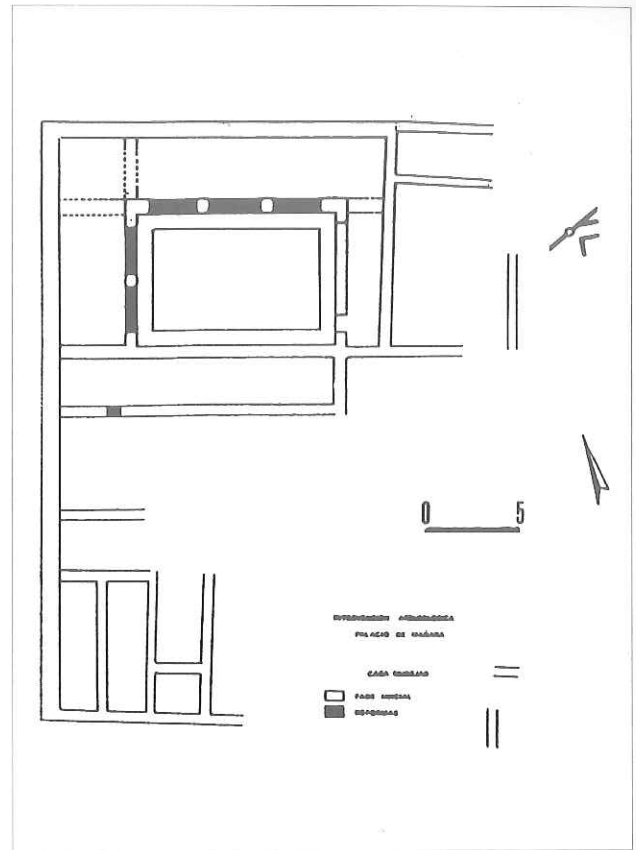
Planta con las estructuras de nueva construcción de la Casa-mudéjar
